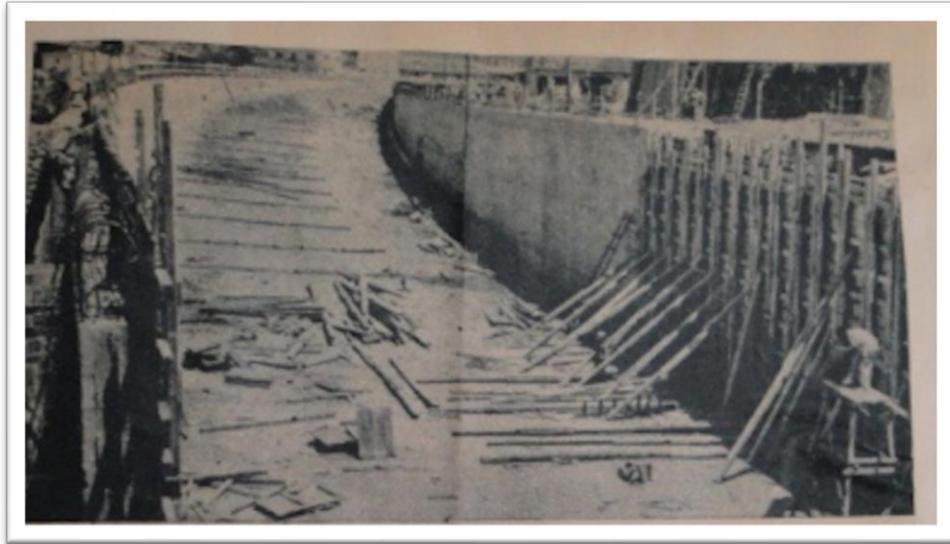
Construcción del paso a desnivel junto al antiguo puente de Nonoalco.
